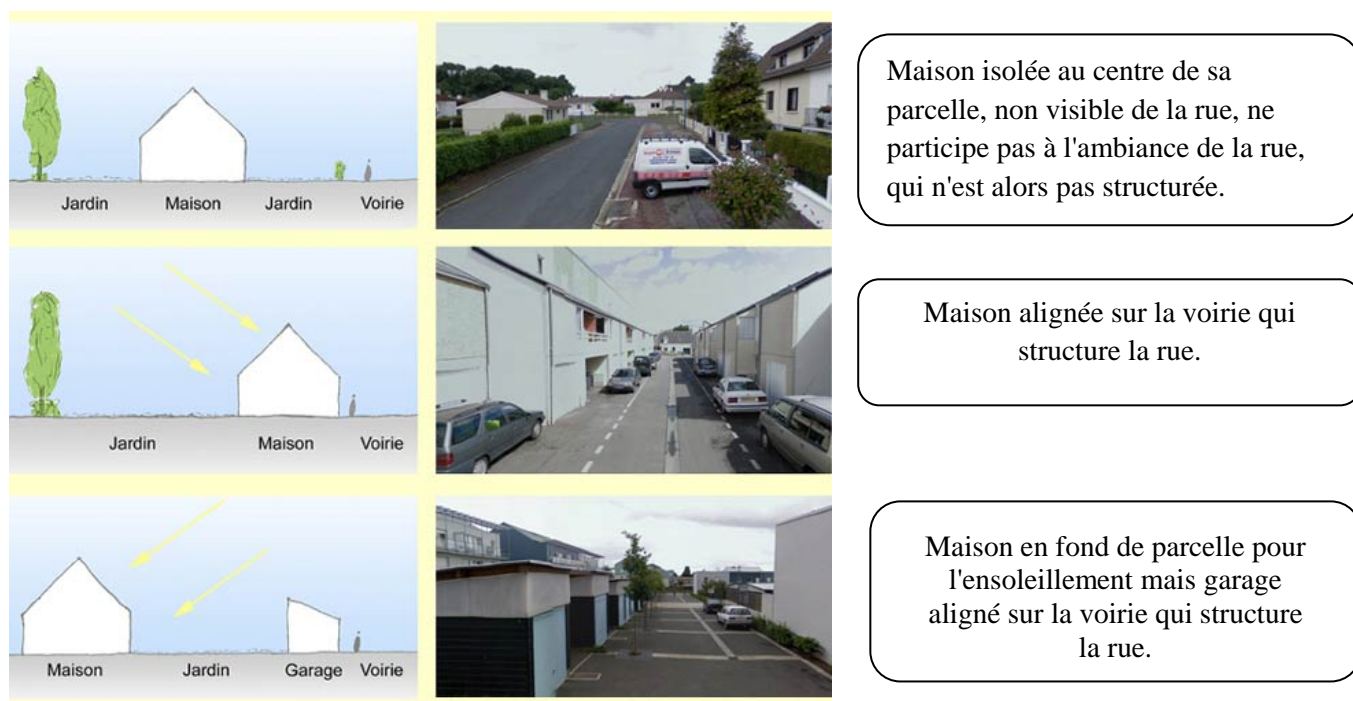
Différentes implantations sur le terrain qui ont un impact sur l'espace public et sur l'organisation intérieure de la parcelle
